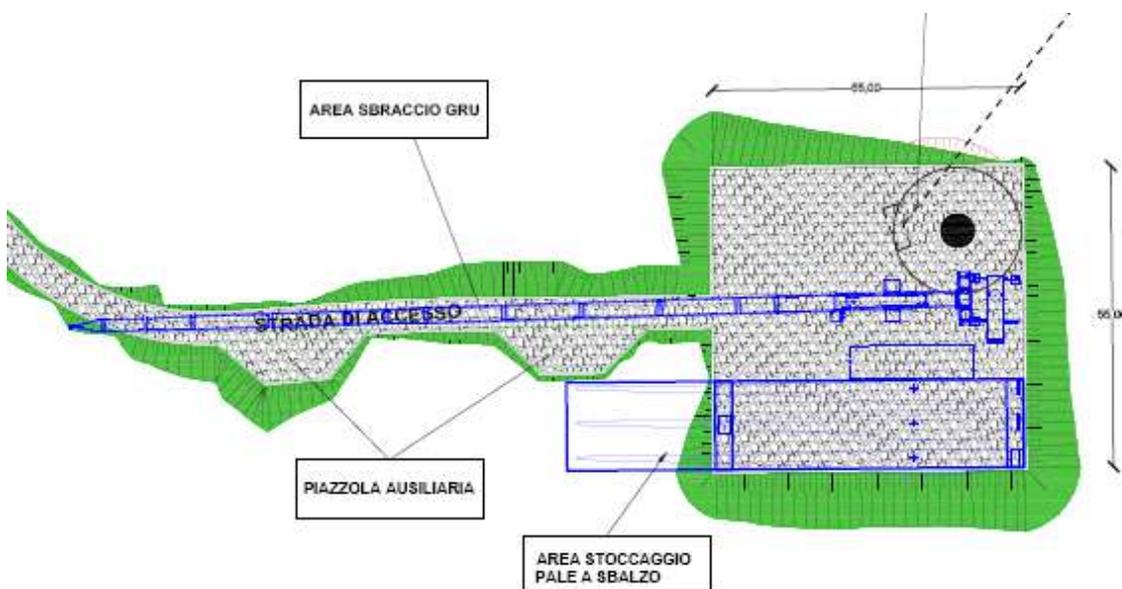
Planimetria piazzola tipo in fase di esecuzione lavori
